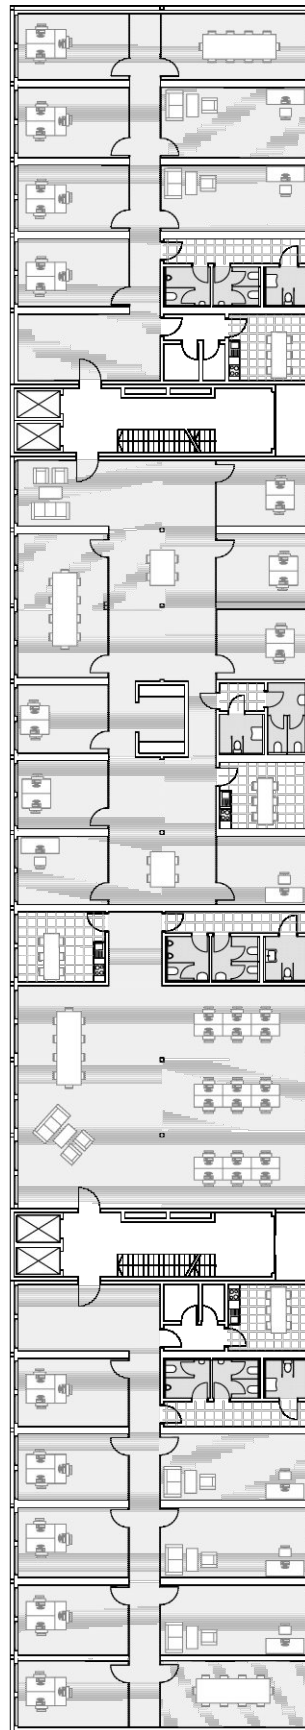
Grundriss 2. Obergeschoss:
